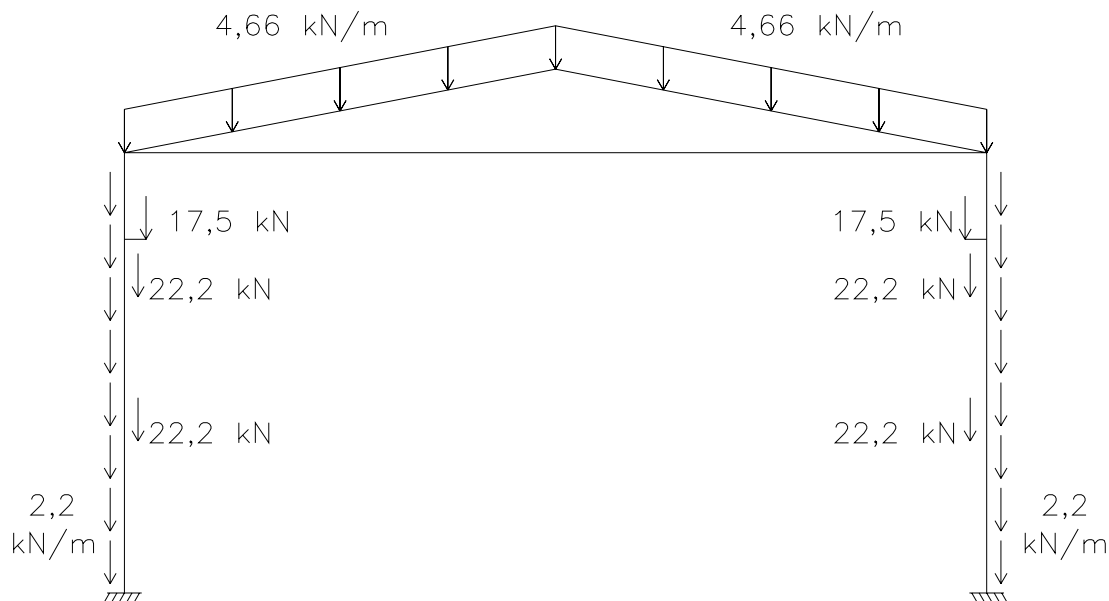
Pórtico utilizado para o sistema de ligação viga-pilar com chumbadores e consolo horizontal (exemplo 6.1).
